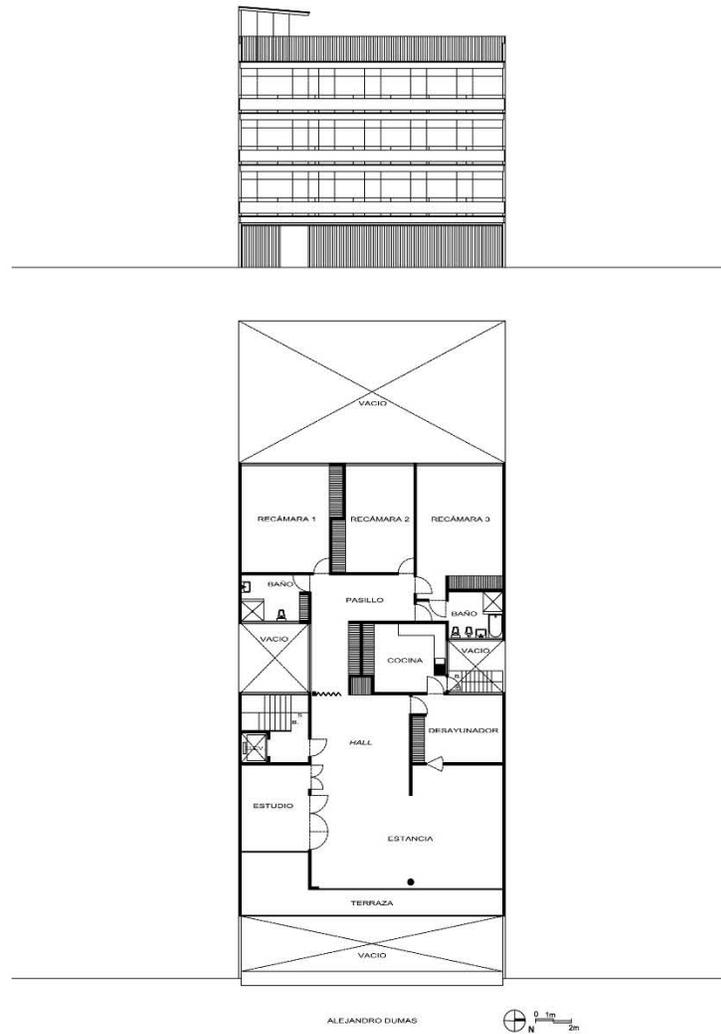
Fachada y planta del edificio ubicado en Alejandro Dumas núm. 154
